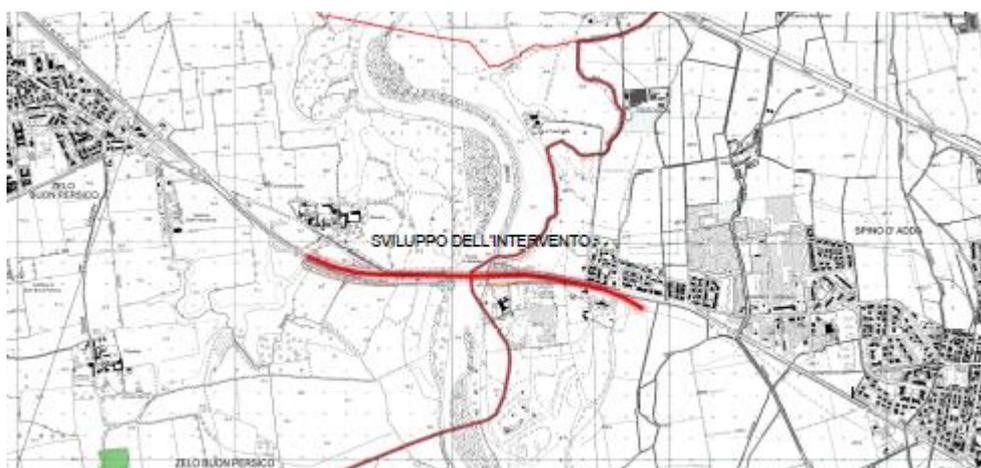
Lotto 3: Nuovo ponte sull'Adda contenente sia le rampe di accesso sia il nuovo ponte sull'Adda
